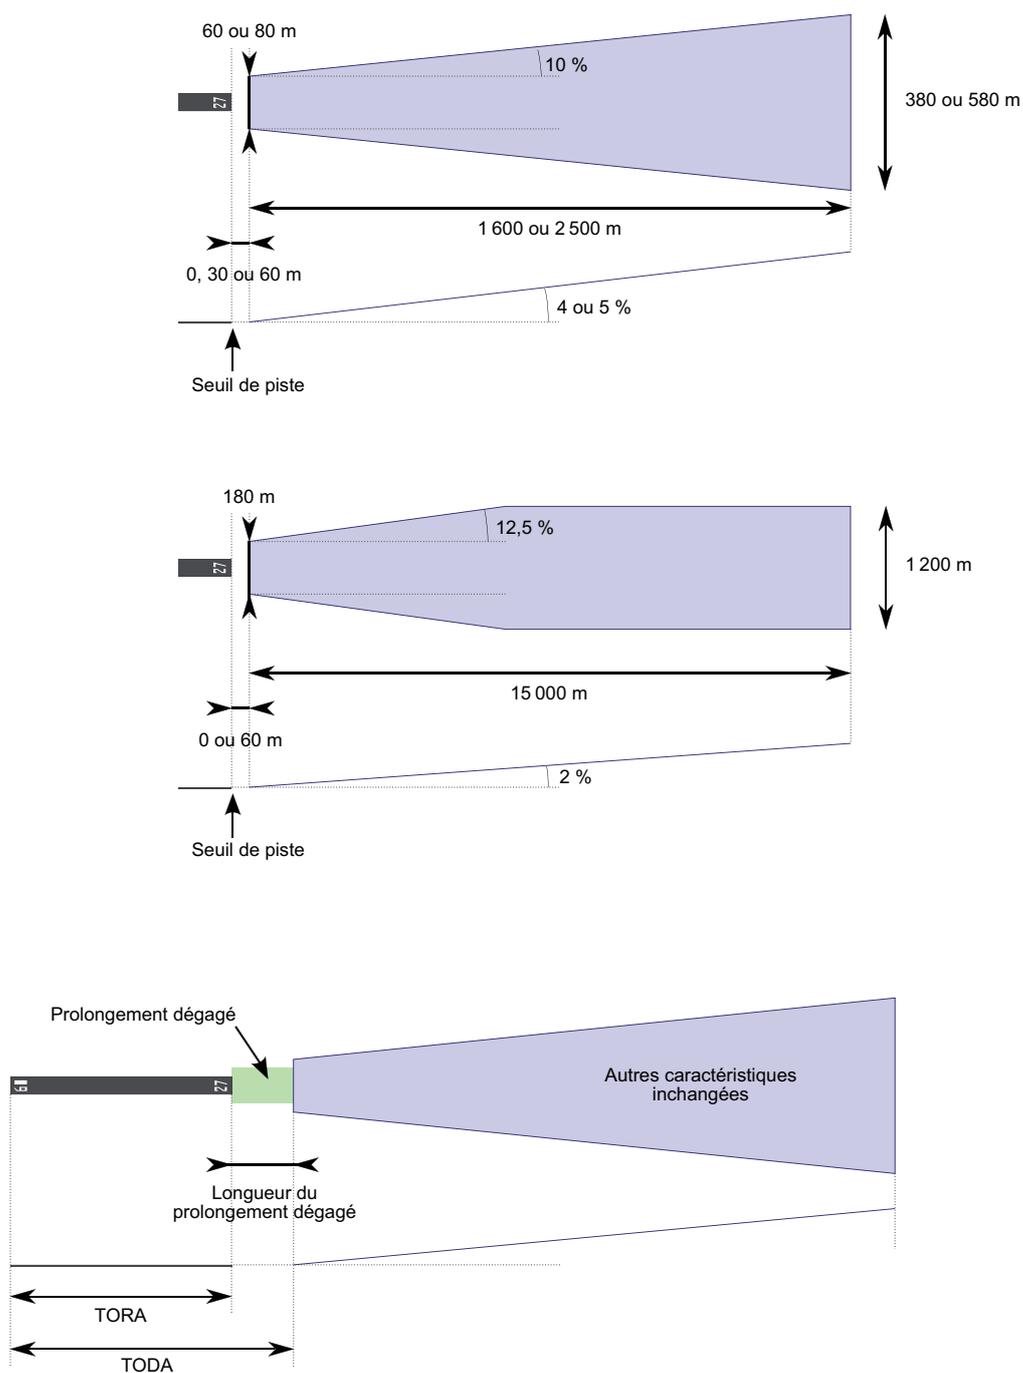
Vue en plan et en coupe longitudinale de la trouée de décollage.
